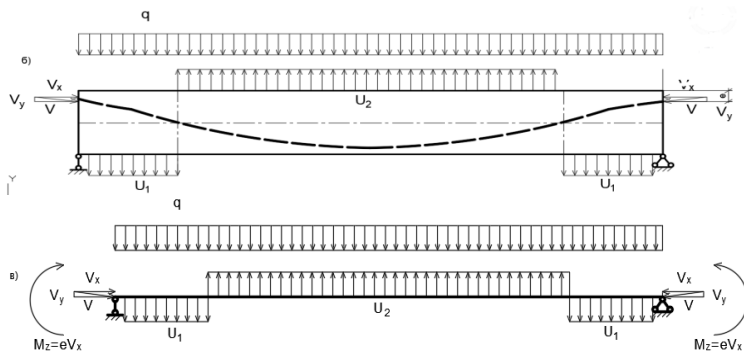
К расчёту перекрытий с постнатяжённой арматурой:
